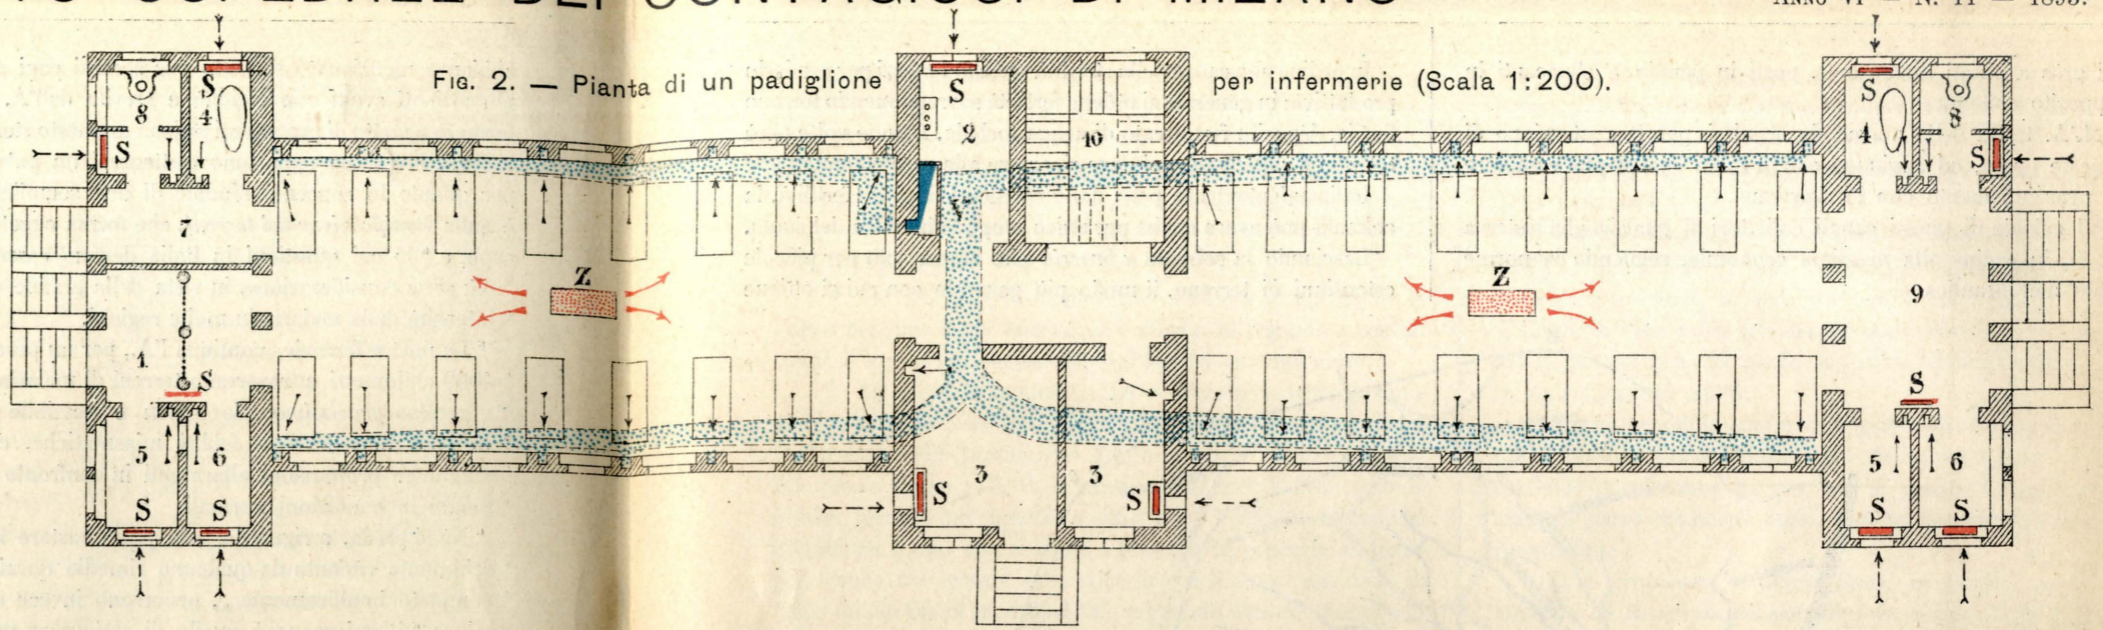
Pianta di un padiglione per infermerie (Scala 1:200).
